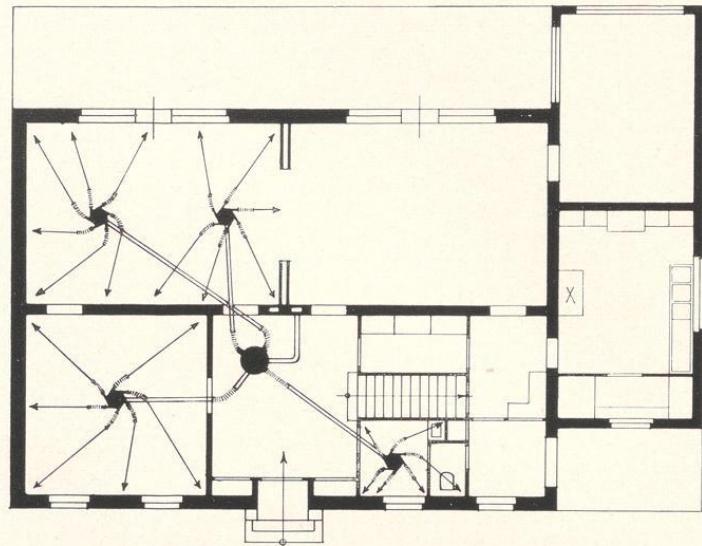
Föhngebläse-Bauaustrockner in der Anwendung, rechts der Heizofen mit Frischluftzuleitung, links das Gebläse mit den Gebläserohren. — Bild 191. Grundriß eines Einfamilienhauses mit den eingezeichneten Aufstellungsorten des Föhngebläses
